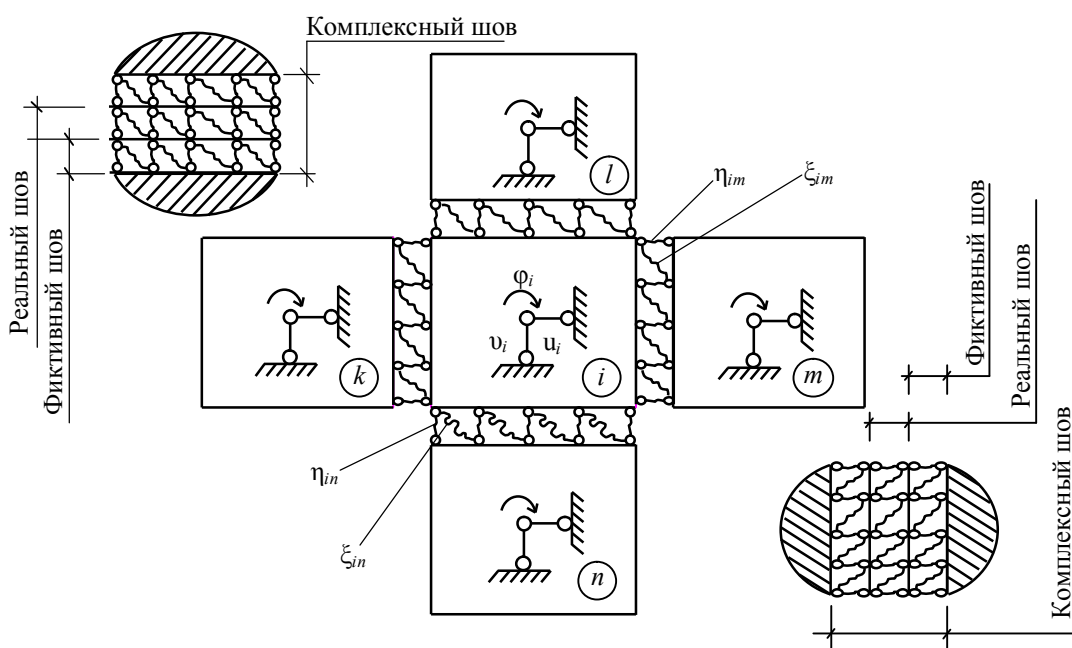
Расчетная модель для сборных железобетонных плит перекрытий
